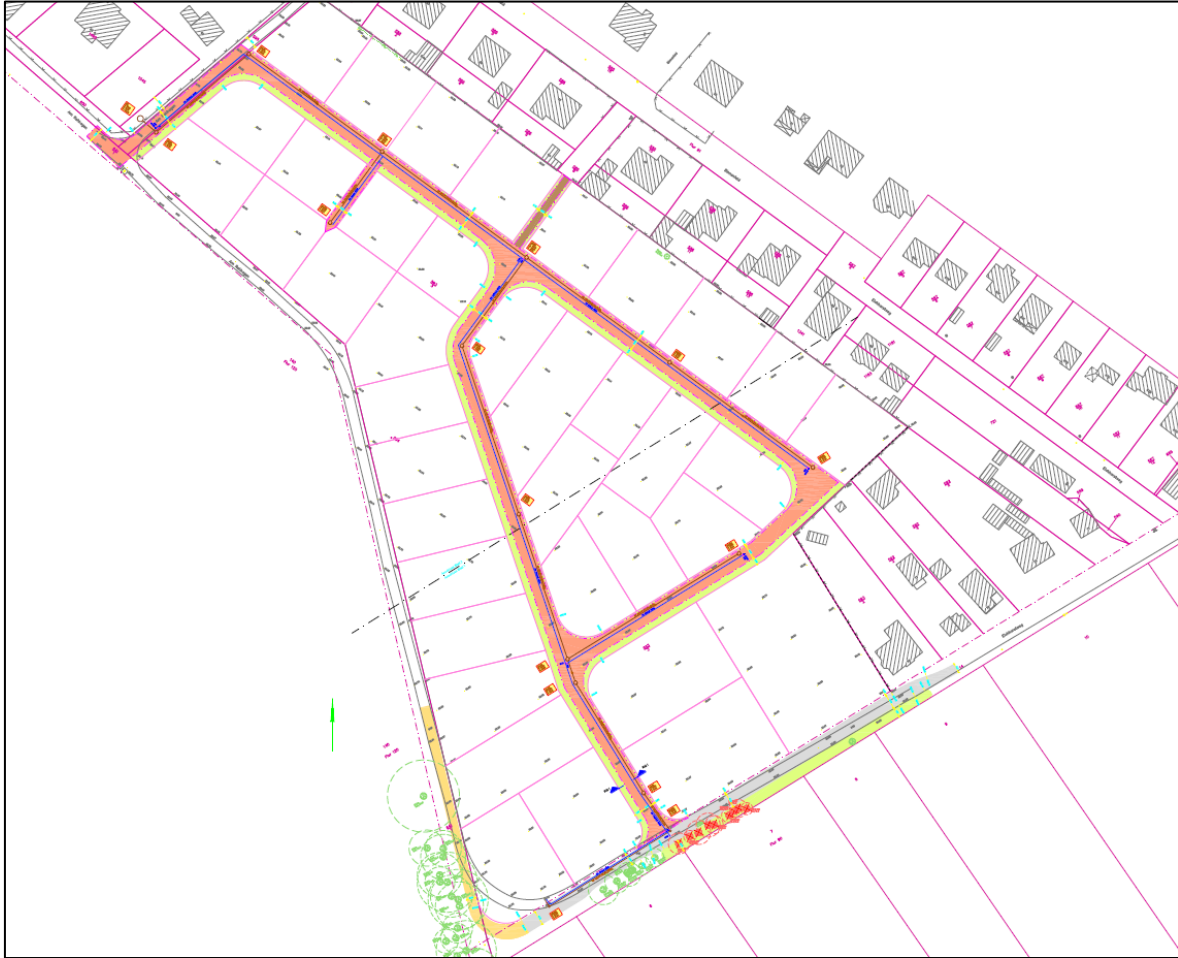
Erschließungsvorplanung (Quelle: IBL Ingenieurbüro Wolfgang Berndt, Lage- und Höhenplan 1 und 2, Stand vom 08.05.2018)
